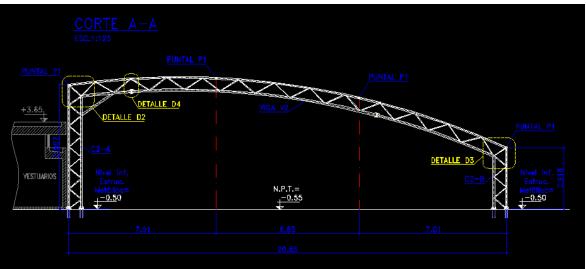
Imagen de proyecto de cubierta metálica para pileta – proyecto parque este
